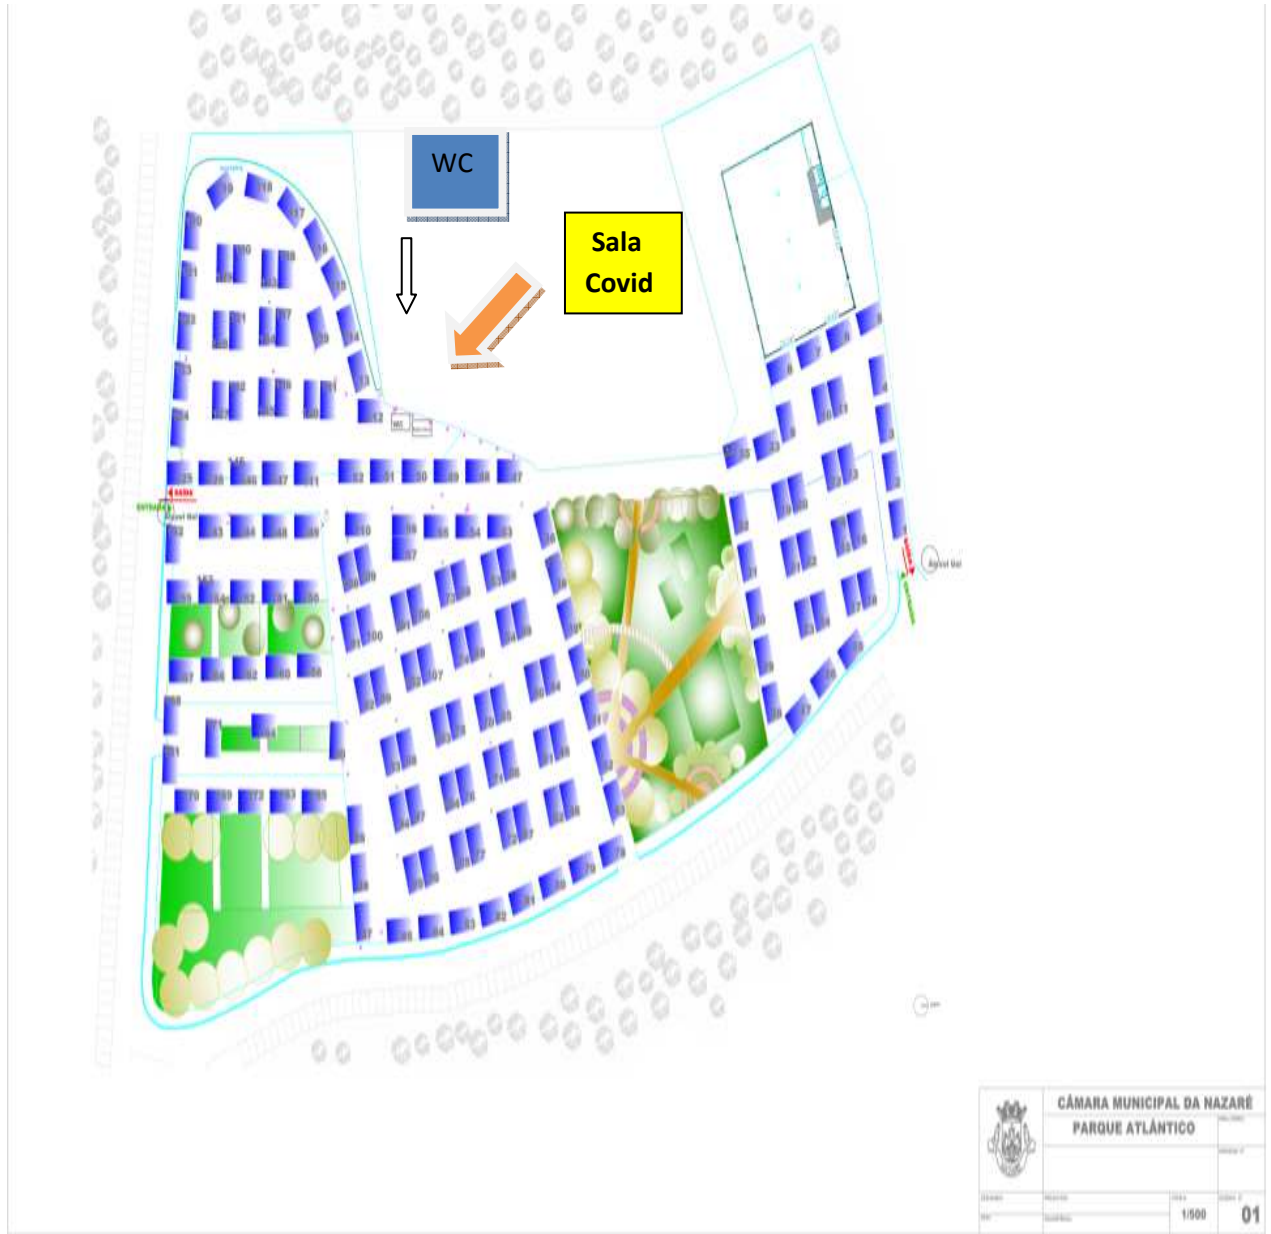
Planta sinalização, WC , desinfetante, entradas/saídas, Sala Covid
